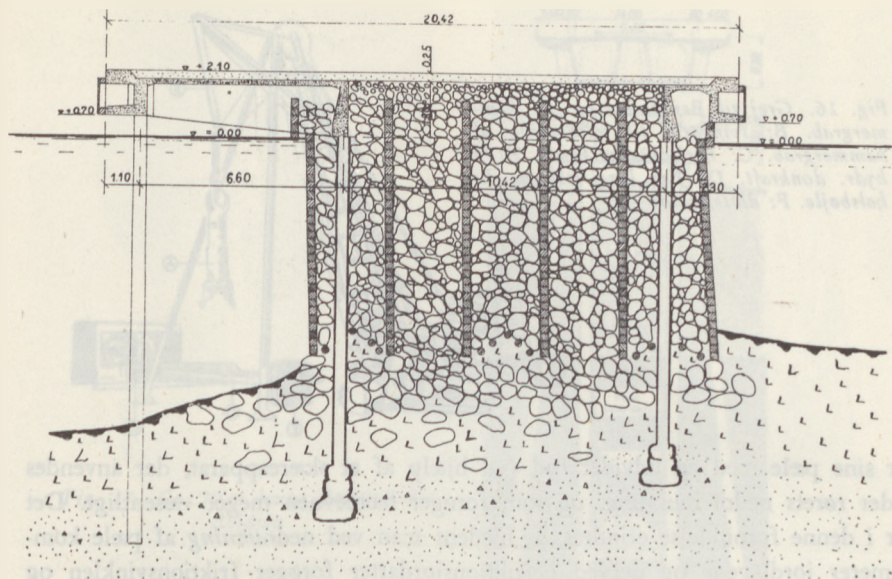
Ombygning af pir i Kotka, Finland. Prefab.-Frankipæle blev rammet gennem de gamle stenfyldte tømmerkister.
